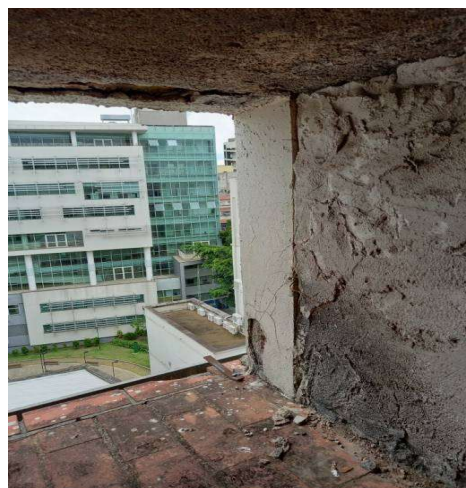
Pilar com deslocamento do concreto e fissuras.
